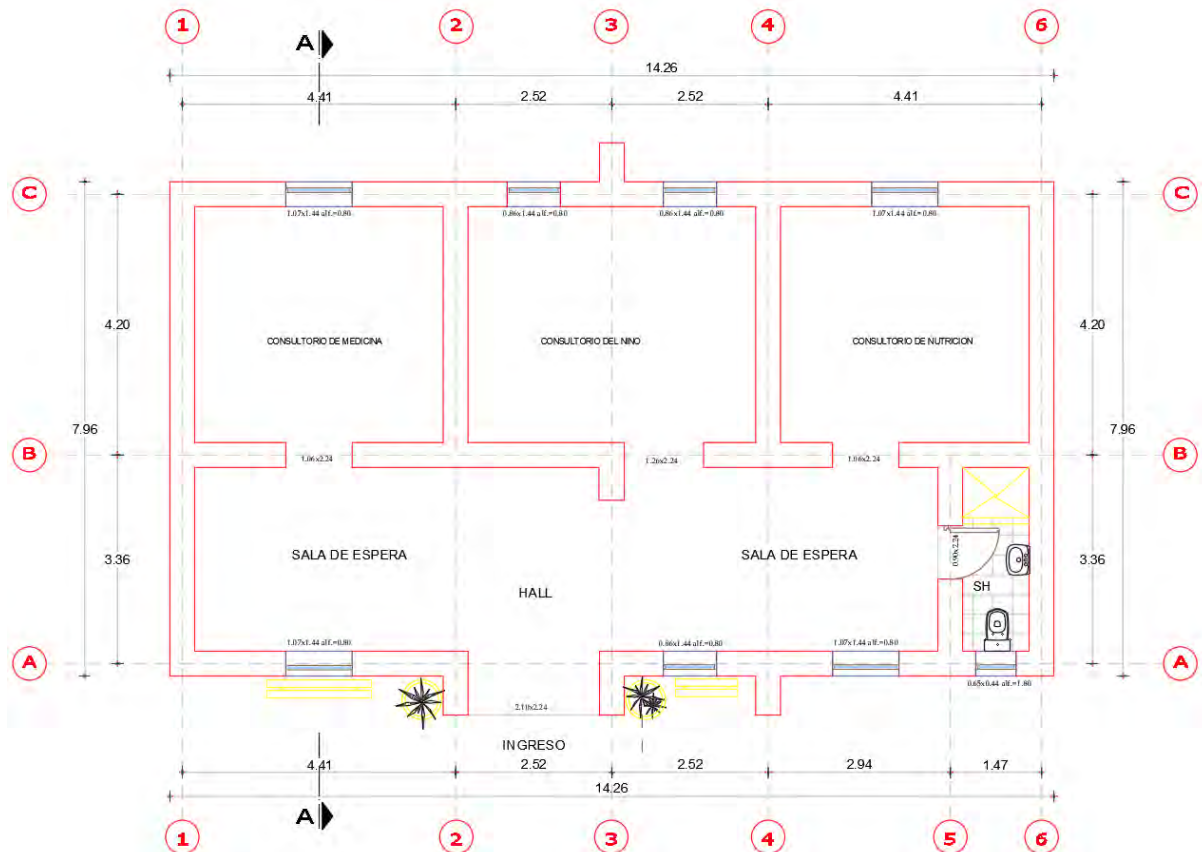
Planta de edificación del puesto de salud de Pampacolca
